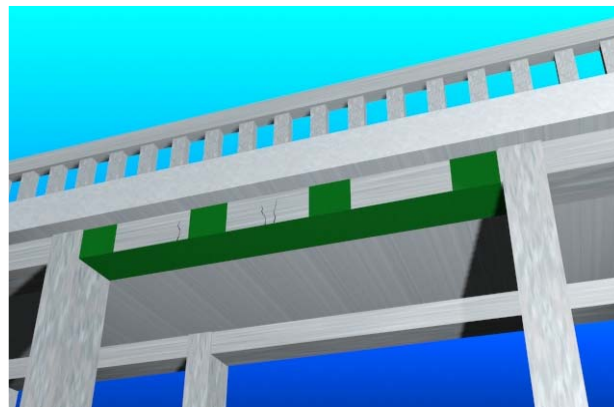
Utilização de laminados como elemento de reforço à flexão associado a folhas para reforço ao corte.
